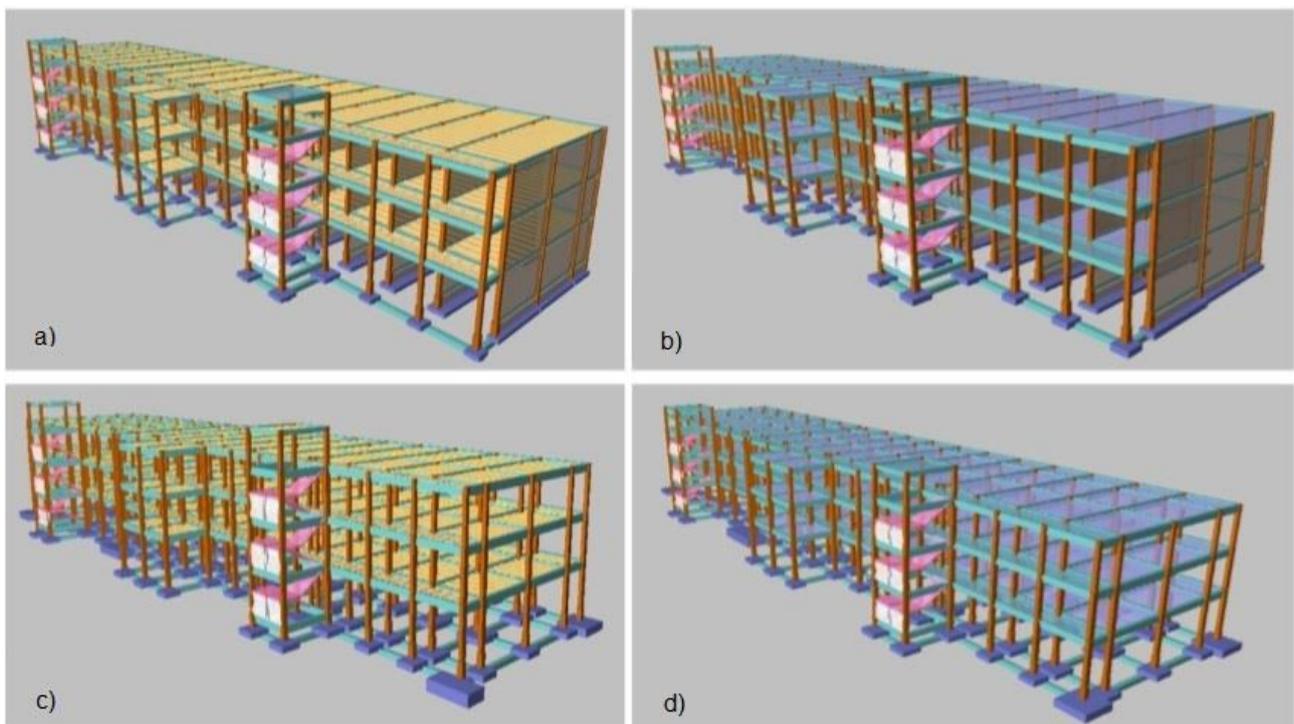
Modelo de las variantes. a) Variante de muros de bloques y pórticos con losas de entepiso y cubierta de vigueta y bovedilla; b) Variante de muros de bloques y pórticos con losas de entepiso y cubierta de Steel Deck; c) Pórticos con losas de entepiso y cubierta de vigueta y bovedilla; d) Pórticos con losas de entepiso y cubierta de Steel Deck. Fuente: Elaboración propia, software Cypecad 2016.
